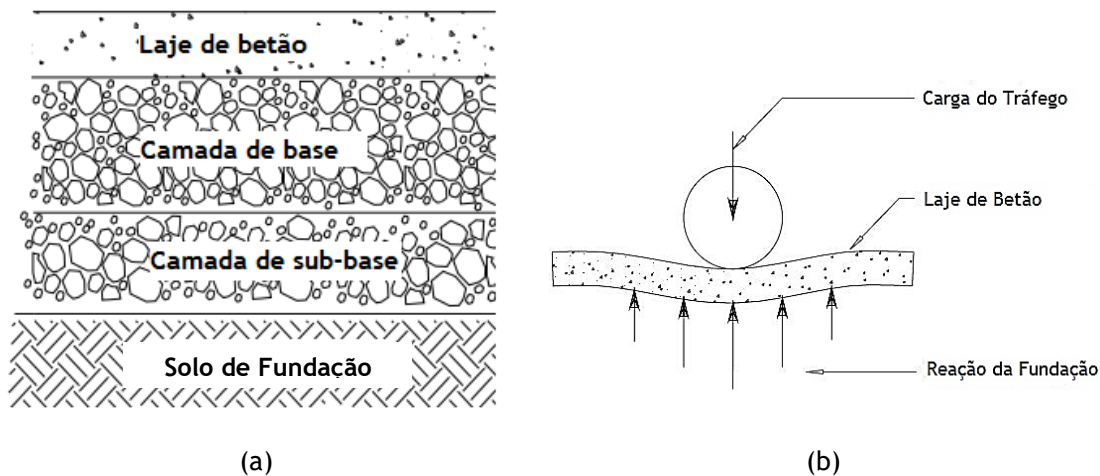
(a) Estrutura típica de pavimento rígido; (b) Distribuição da carga do tráfego num pavimento rígido (adaptado de AC 150/5380-6C, 2014).
